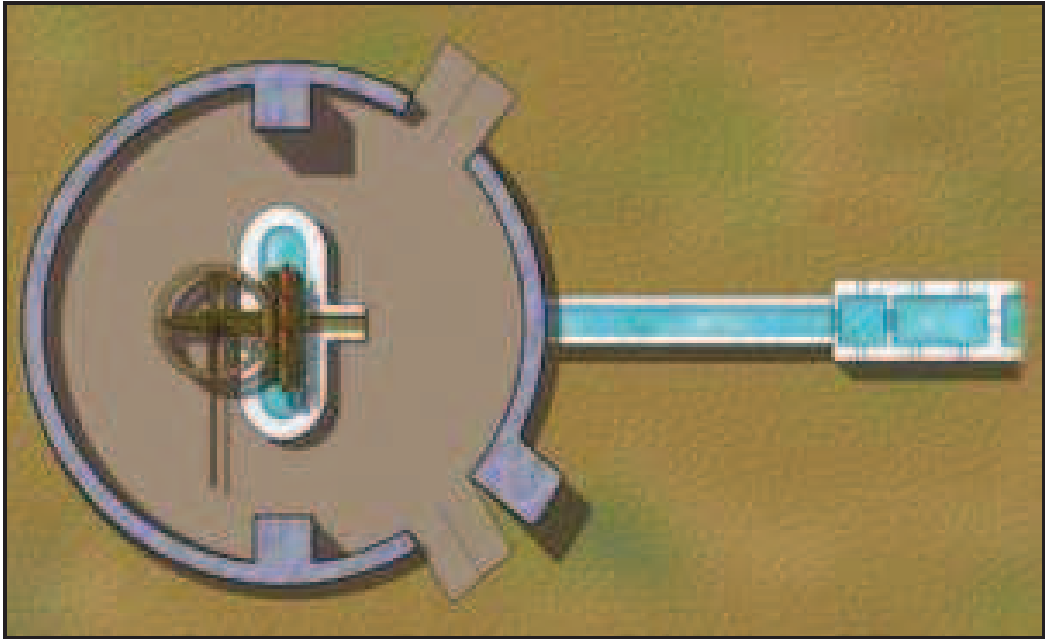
Imagen de una noria en planta. Obsérvese la plataforma elevada que alberga la noria, el canal de desagüe y la alberca final de recepción.
